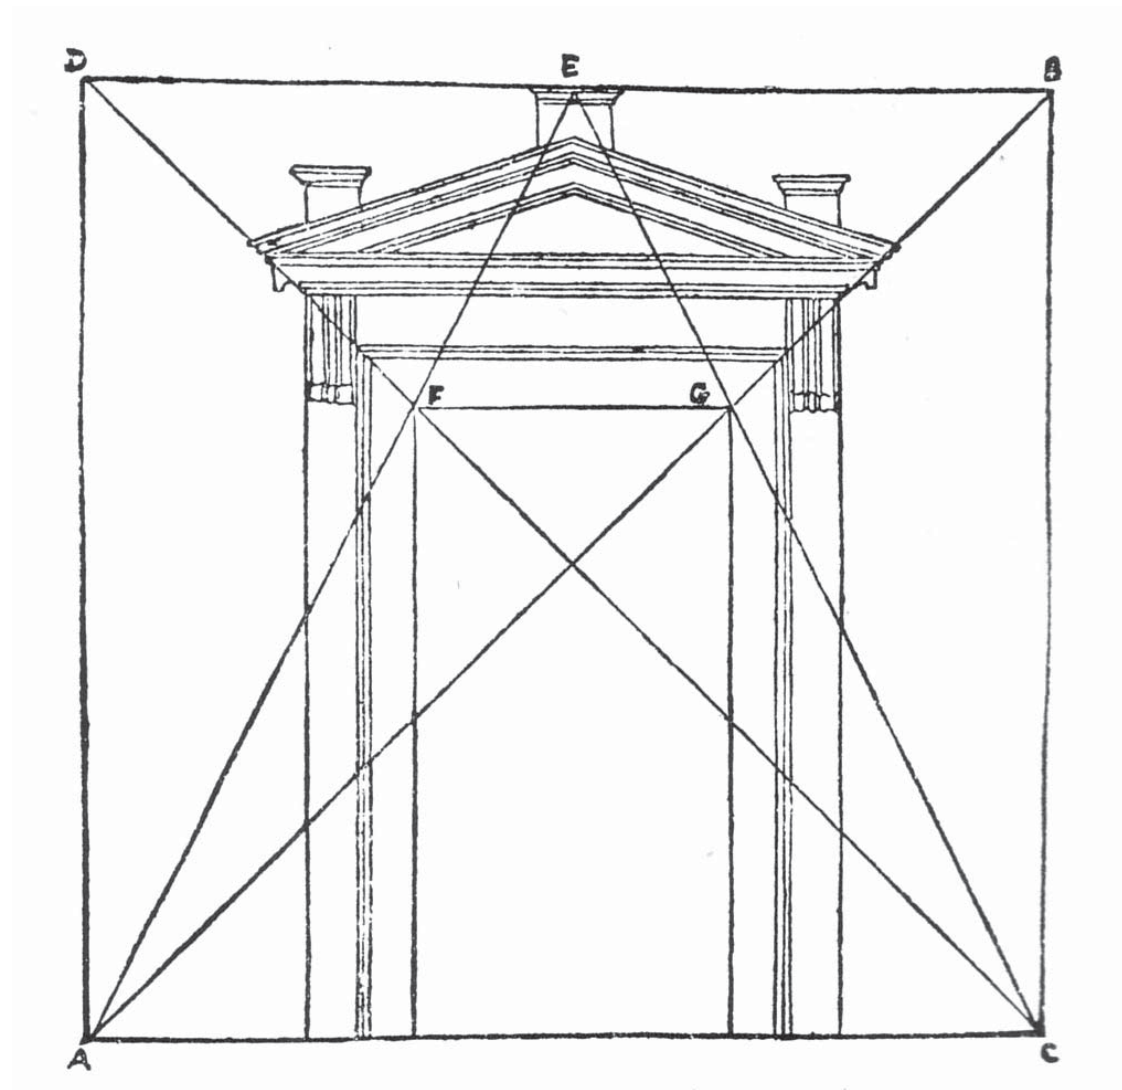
Construcción de una puerta. Del "Primer Libro" de Serlio.
